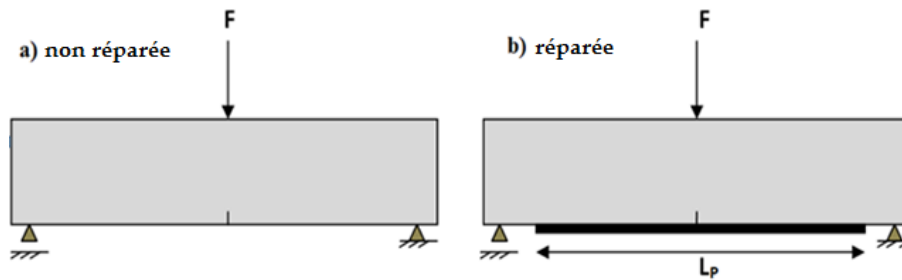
Poutre pré-fissurée soumise à la flexion (avant et après renforcement)
